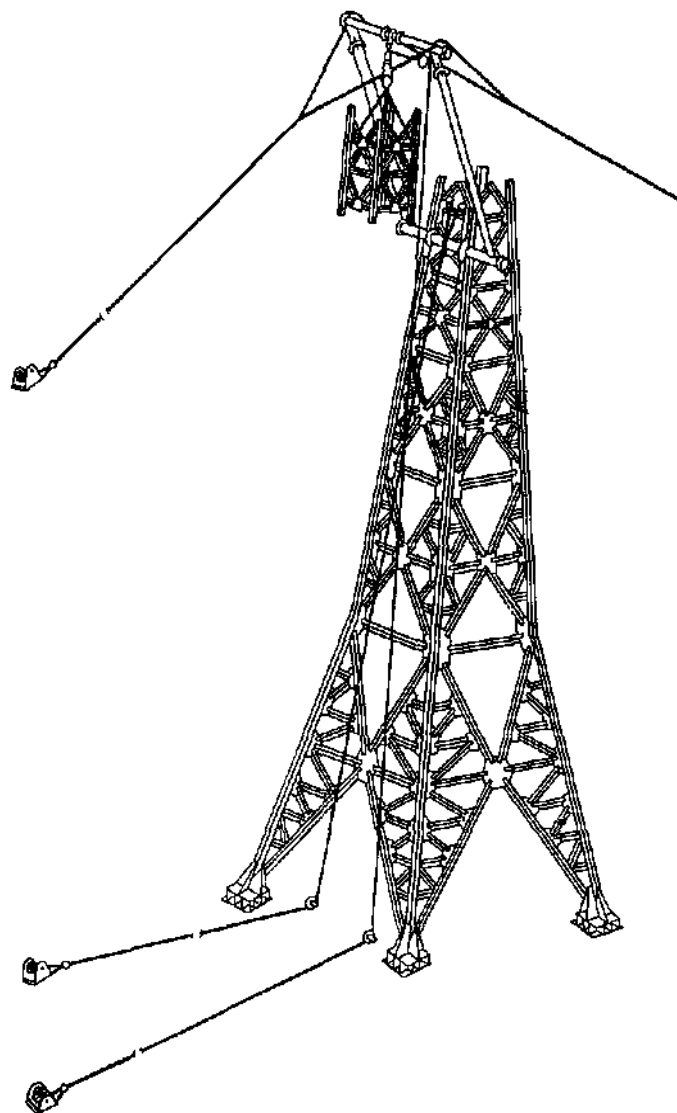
Монтаж металлической опоры методом наращивания
